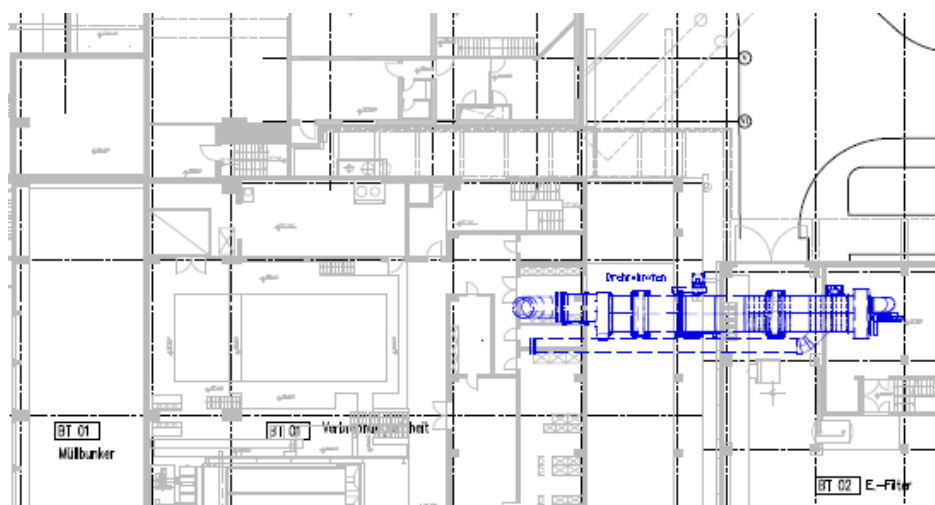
Grundriss der Aufstellungsvariante Drehrohrofen.
